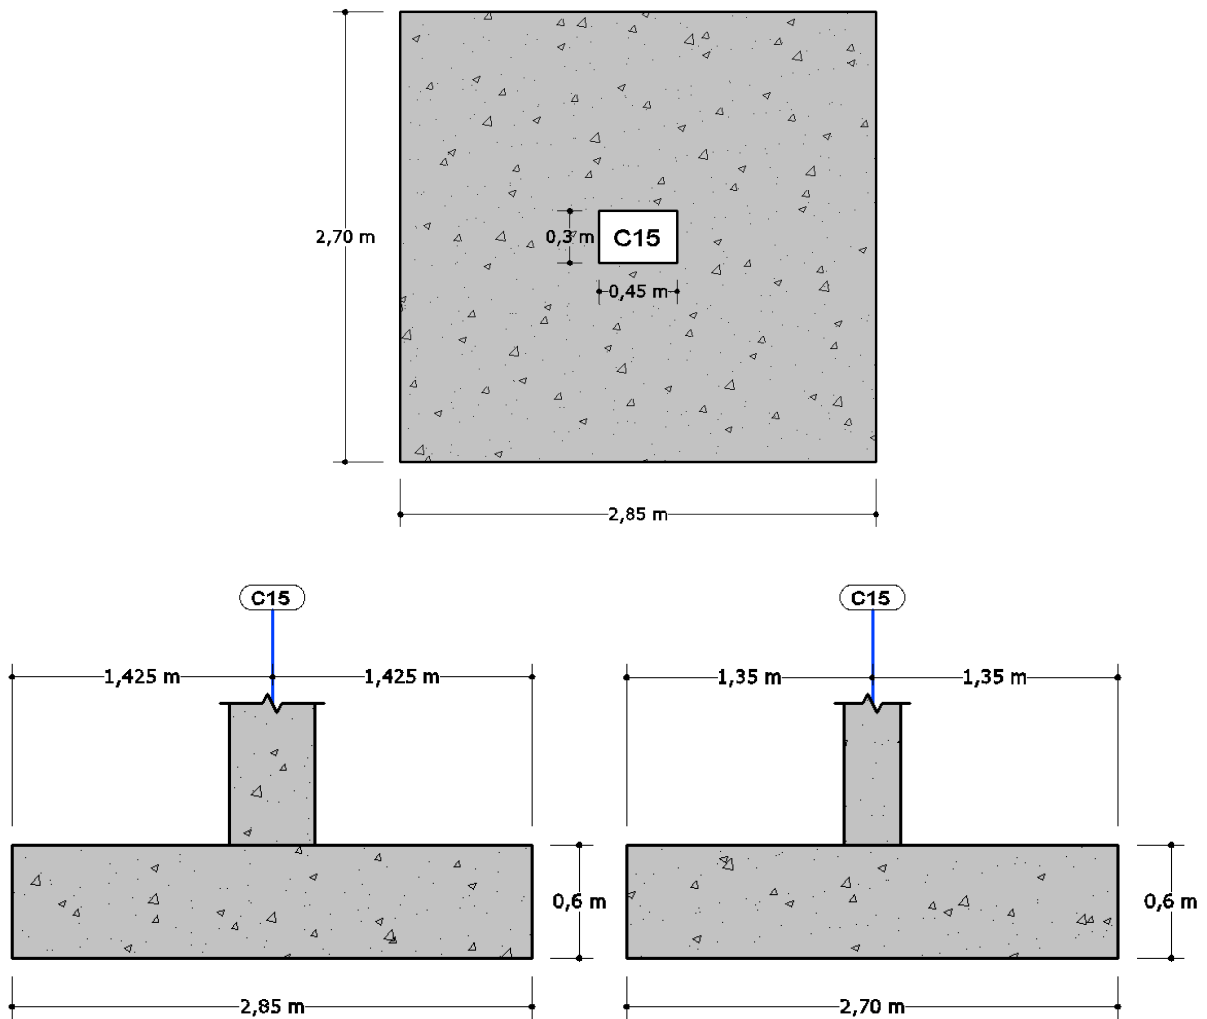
Dimensiones Zapata Centrada; Elaboración Propia
